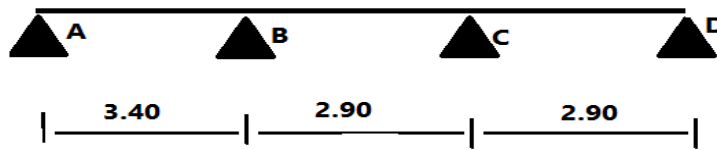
Schéma du 2^{eme} type de poutrelle.
